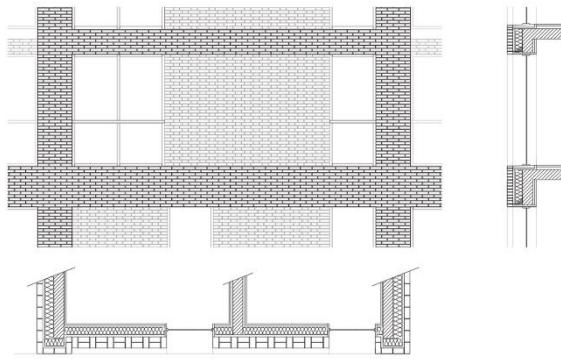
Extrait de façade d'un bâtiment de logement collectif. Projet personnel ENSAPLV S5.
